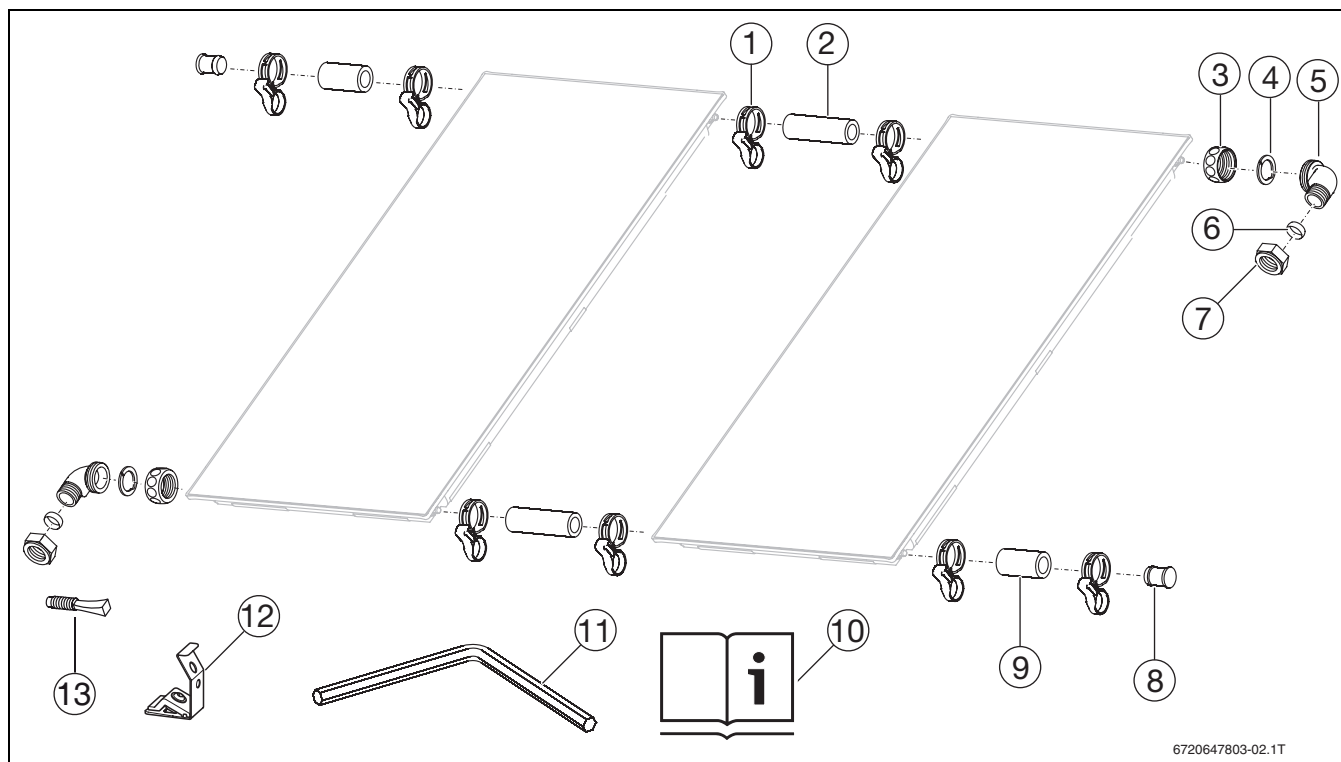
1 set di collegamento per installazione su tetto piano e 2 set di raccordo
